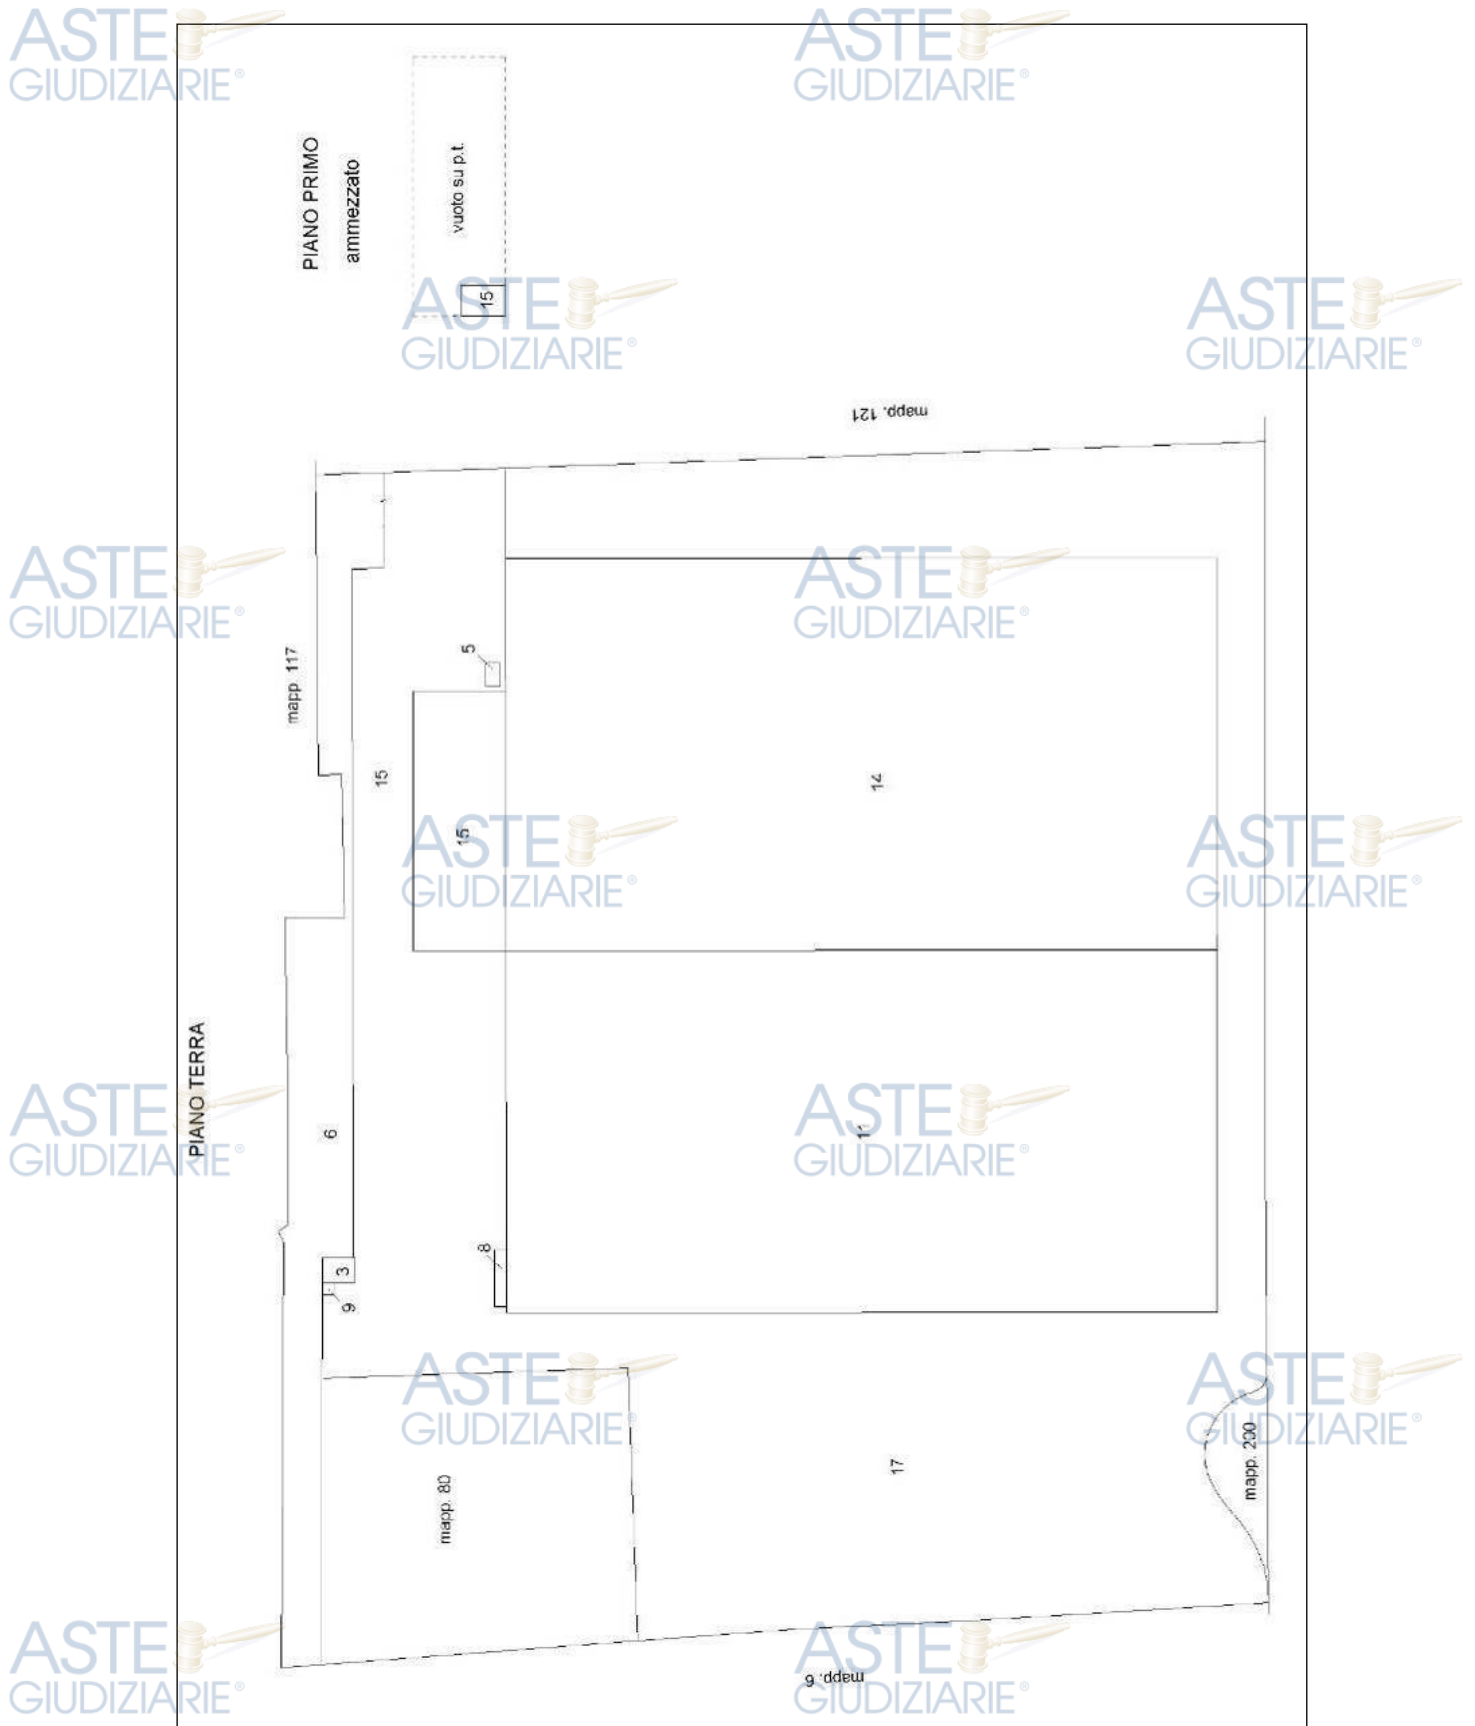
Estratto elaborato planimetrico catastale – PIANO TERRA
